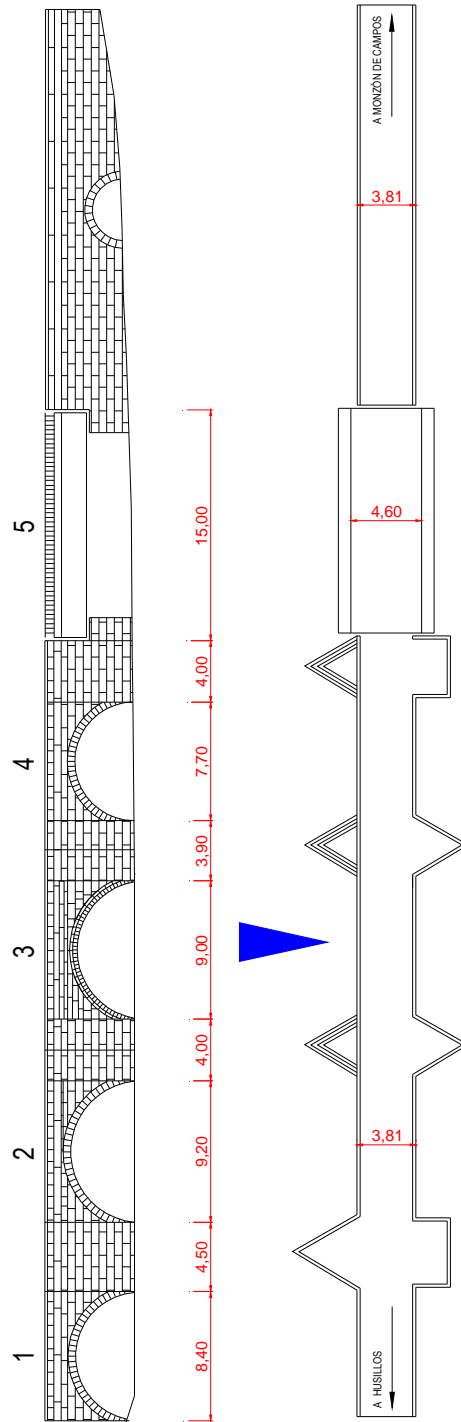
Dibujo en planta y alzado del puente en Husillos.
